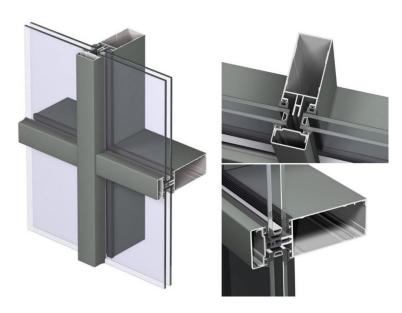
Sistema de muro cortina tipo "stick" Reynaers CW50
